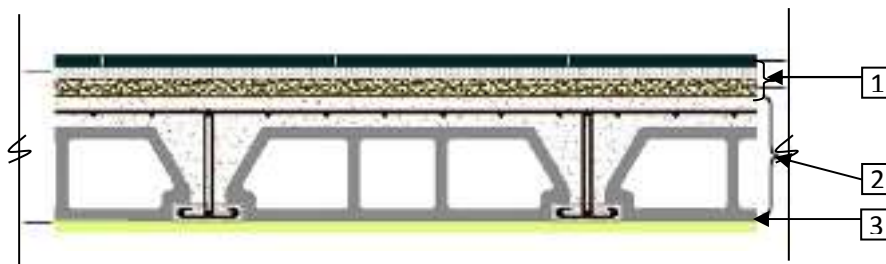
Coupe transversale d'un plancher terrasse inaccessible
